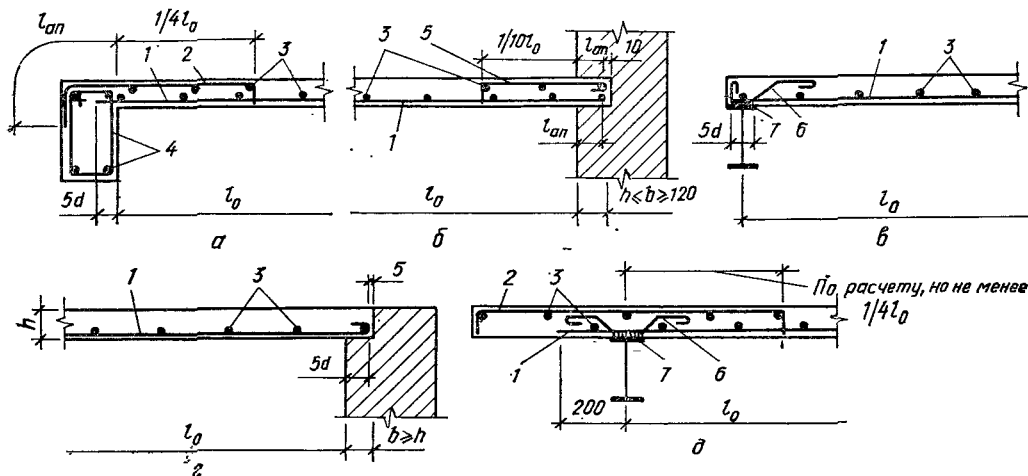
Раздельное армирование крайних опор монолитной плиты отдельными стержнями в рабочем направлении:
